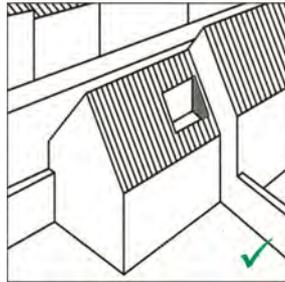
Dacheinschnitt im rückwärtigen Bereich
